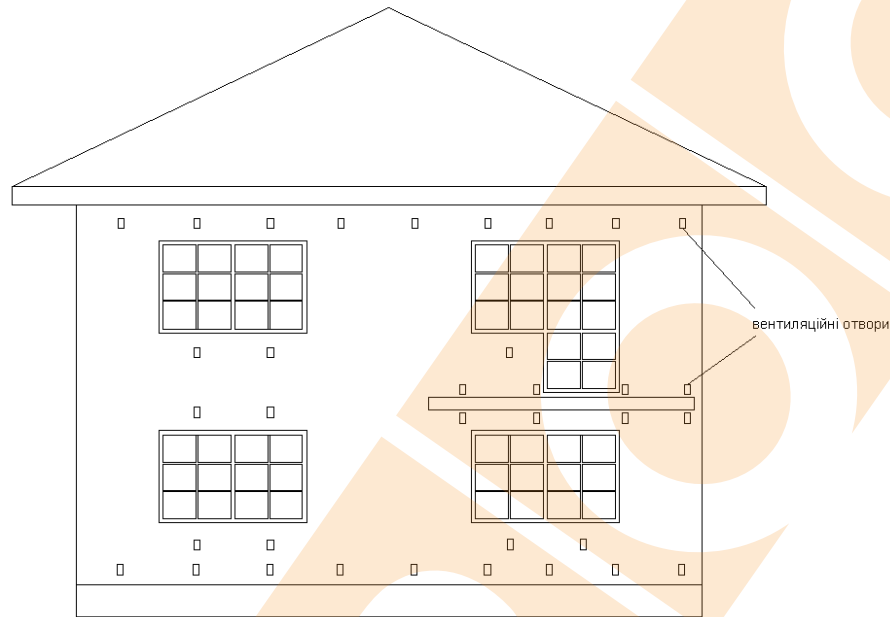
Схема владштування вентиляційних отворів в кладці опоряджувальної цегли по фасаду будинку
